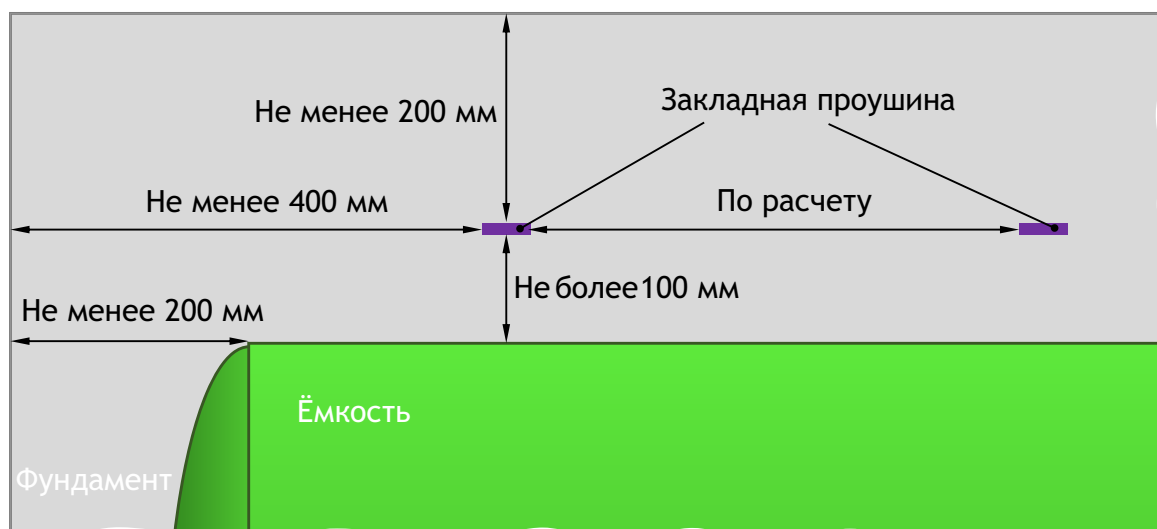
Закладка проушин на фундаментной плите (вид сверху)
